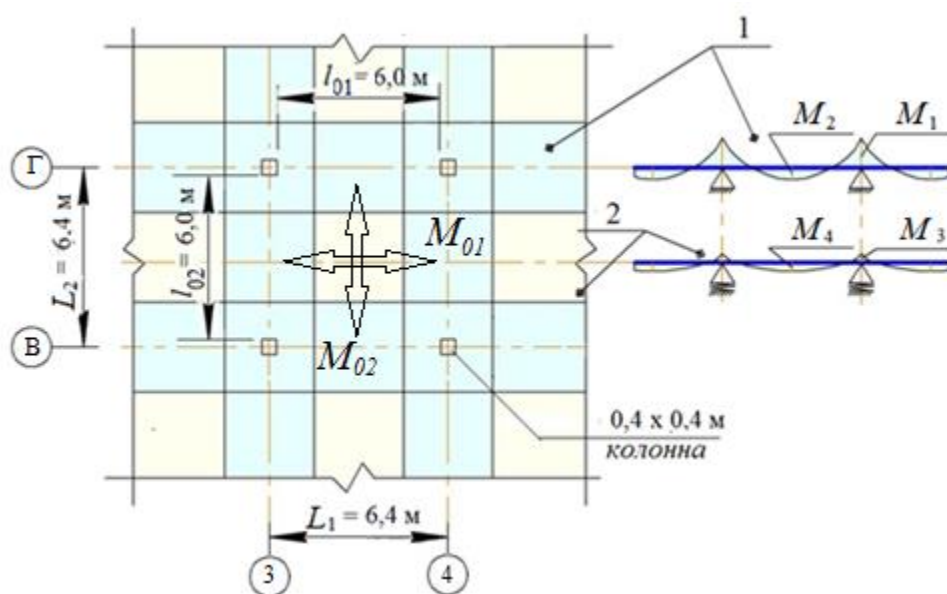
Схемы к расчету плоской плиты перекрытия методом вырезания полос (1 – надколонная полоса, 2 – пролетная полоса)
